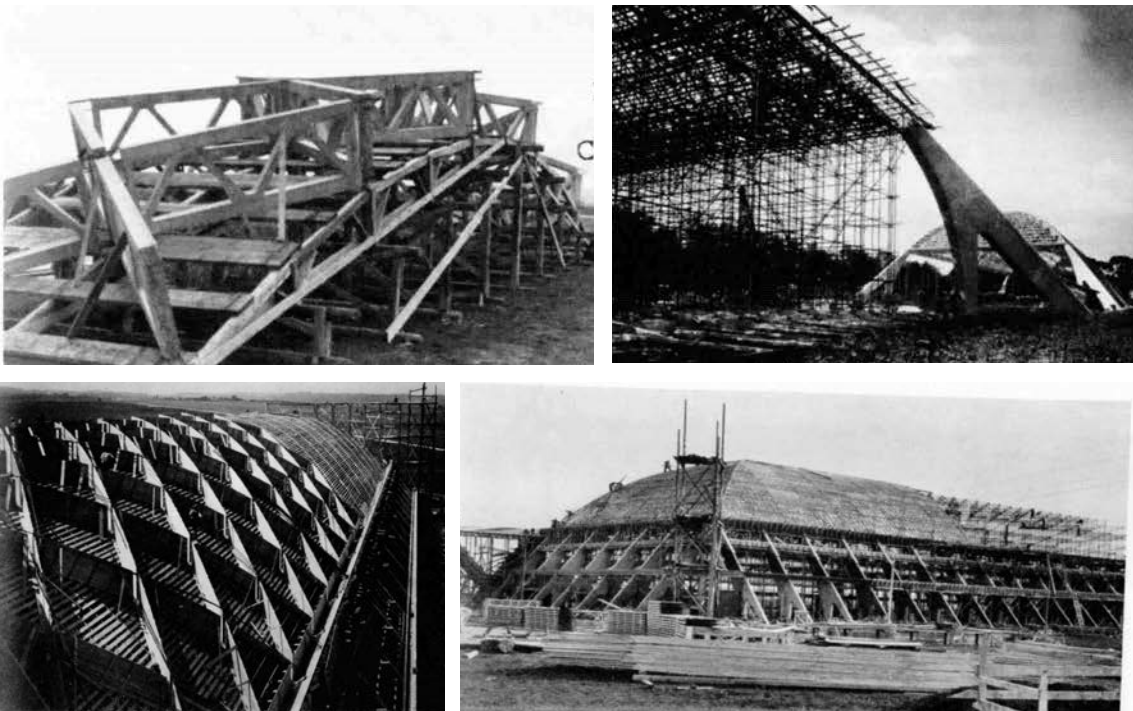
Secuencia de construcción del proyecto de nervaduras estructurales.
